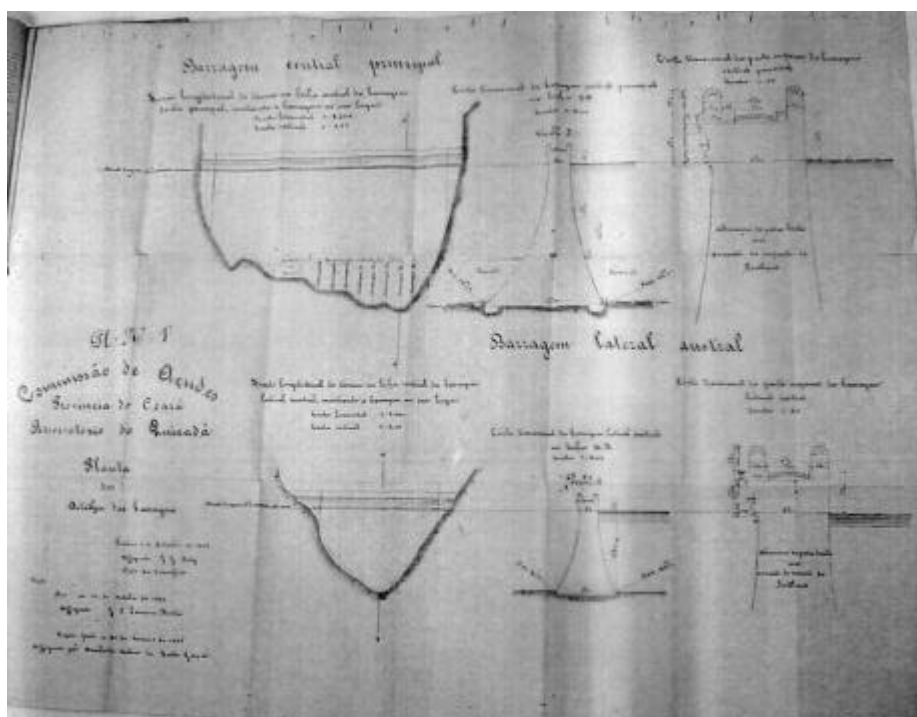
Planta Baixa do Reservatório de Quixadá.
